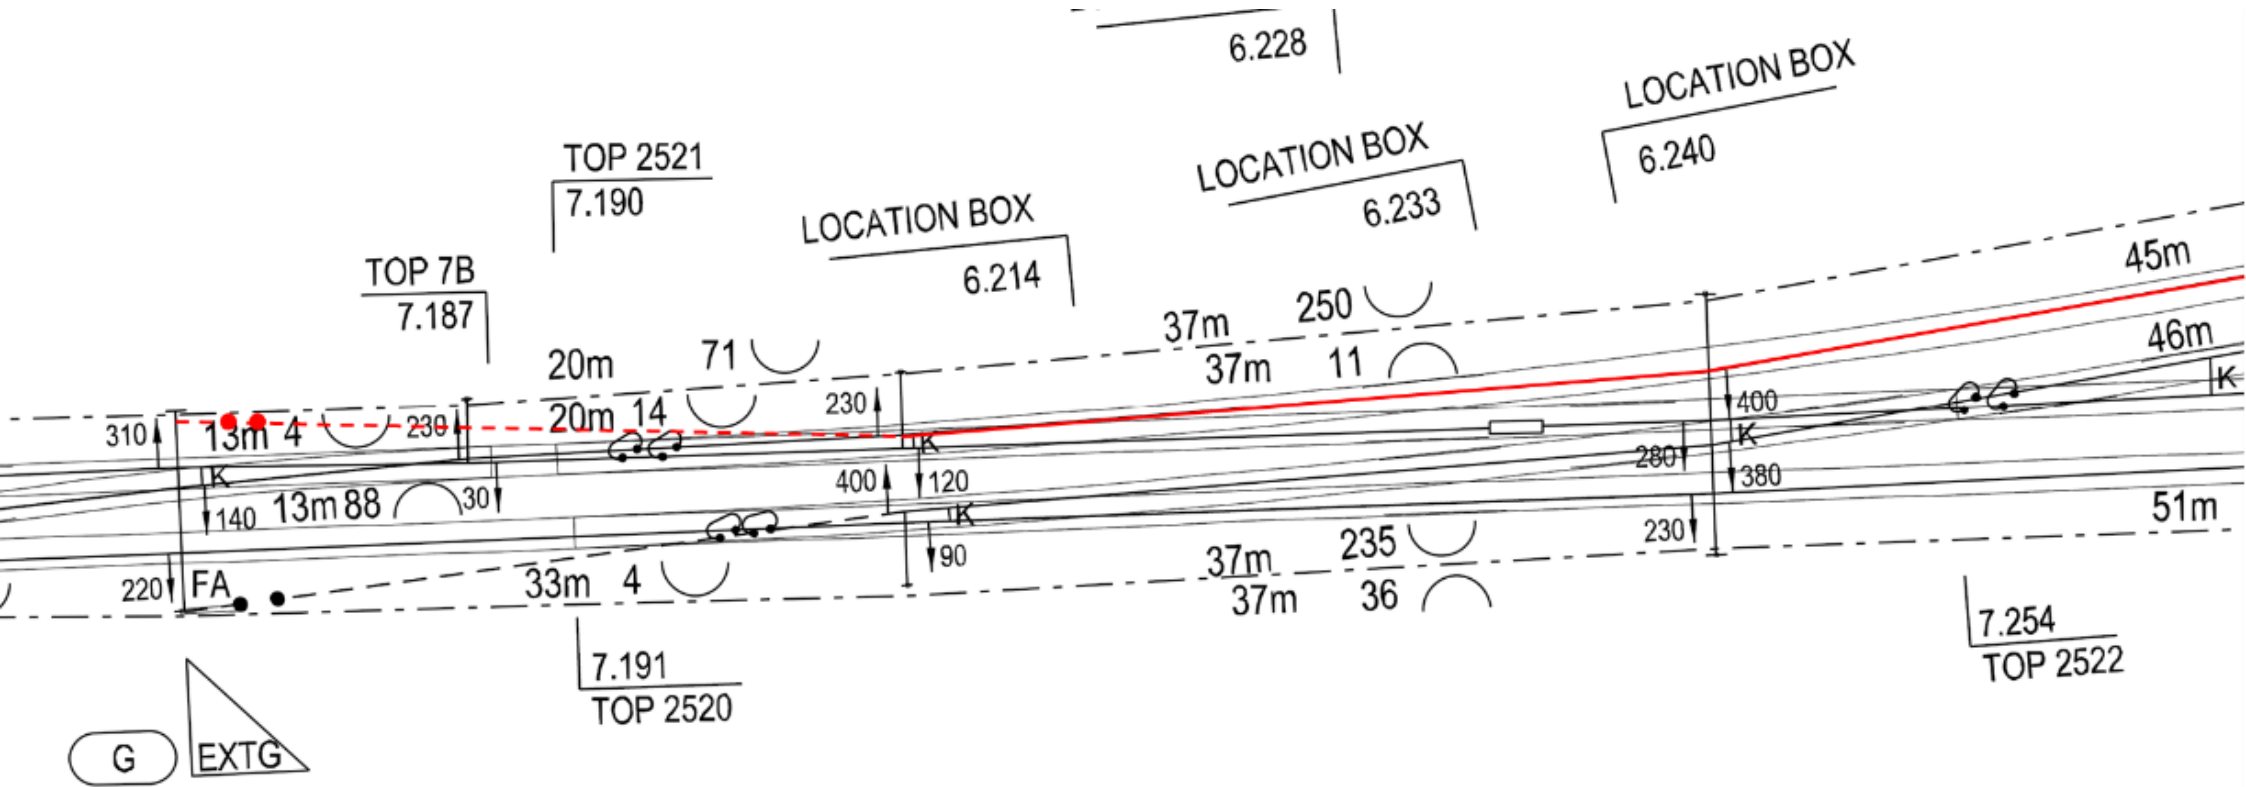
Plano de la instalación de la modificación de la propuesta 1
